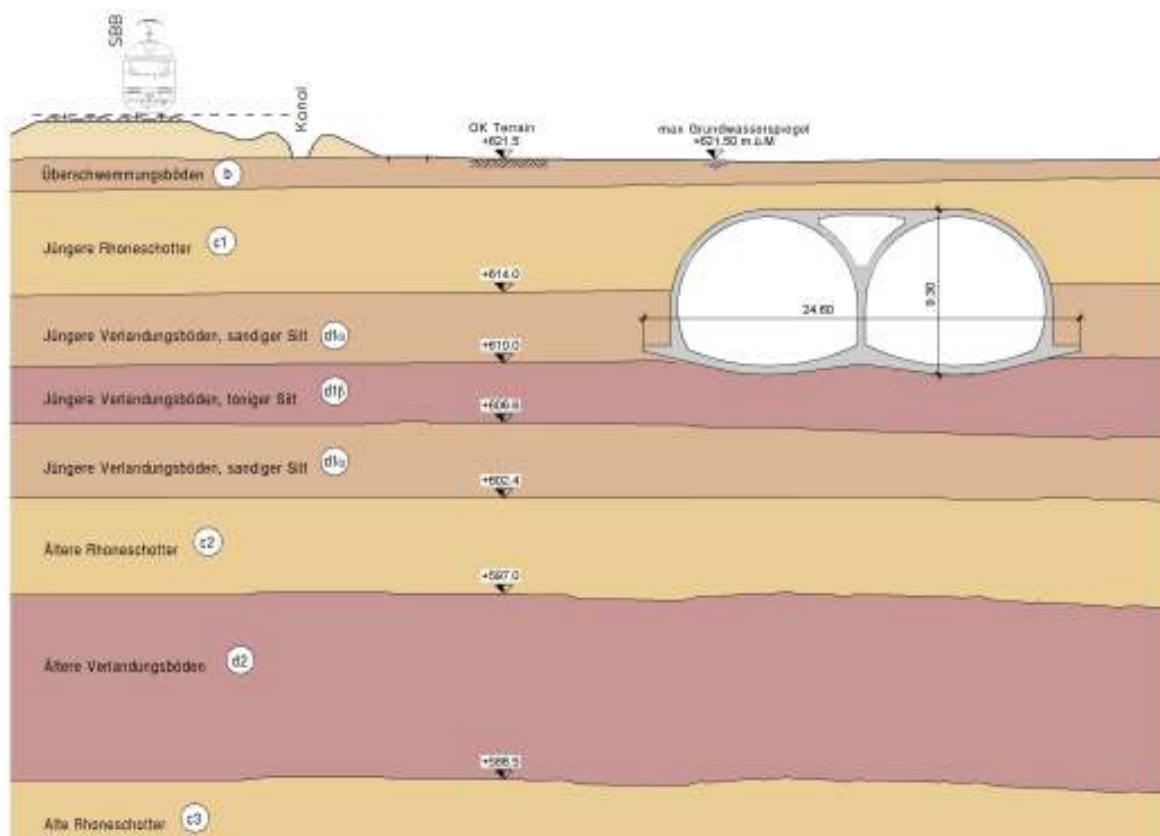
Baugrundaufbau, Querschnitt Tunnelröhre
